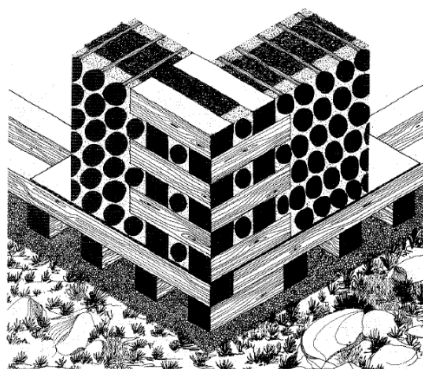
Sistema "stackwall" ou "stovewood" (Clayton, 1990).
